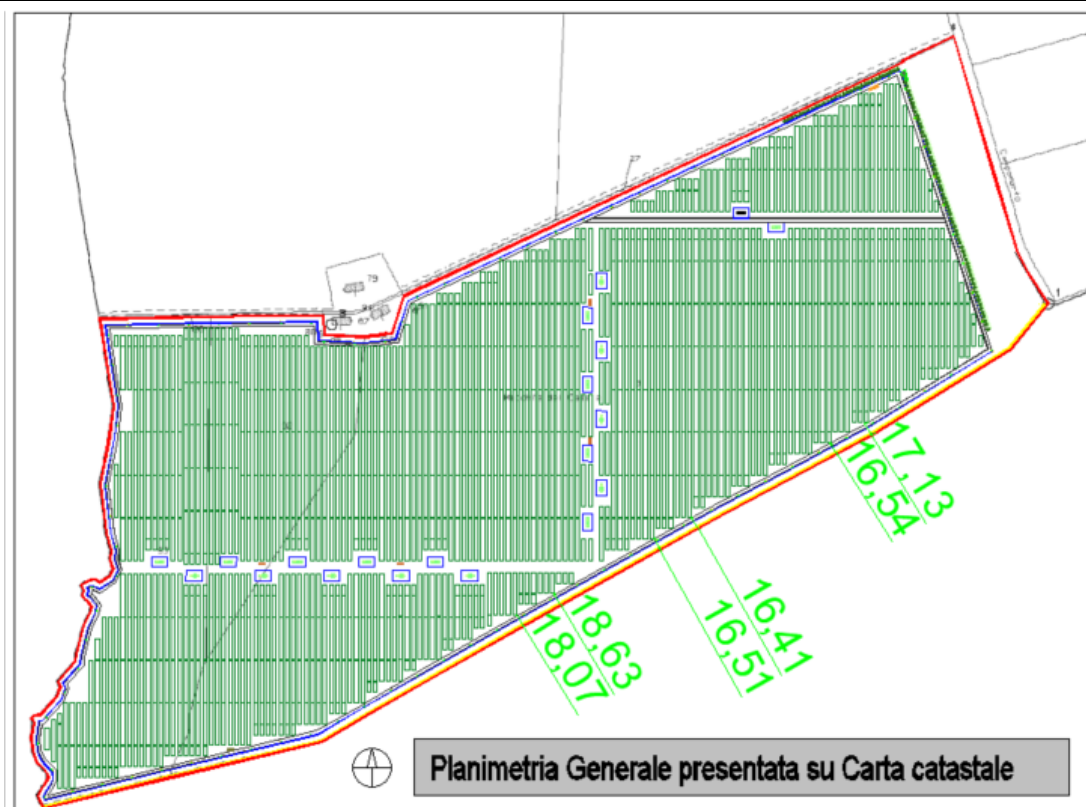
Planimetria di progetto presentata con istanza del 9/3/2022
